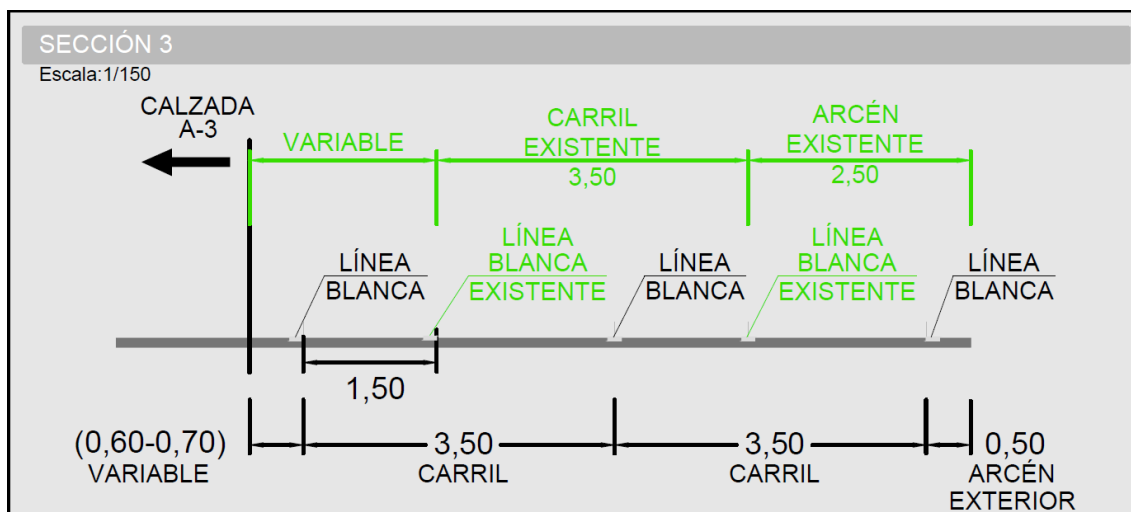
Sección 3, Planta general sobre cartografía, N° de plano 2.5.1, hoja 4 de 7 (Fuente Proyecto 33-V-7500 [21])
